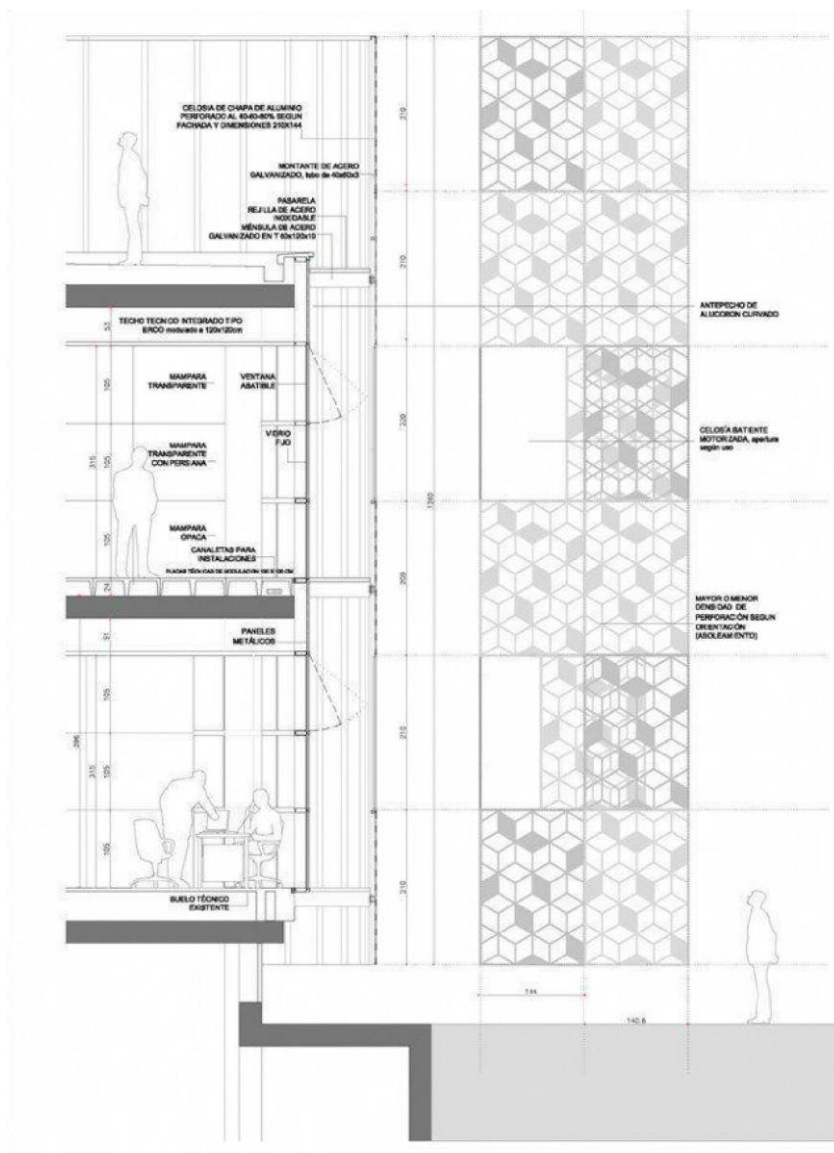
Detalles constructivos que muestran secciones de fachadas.
